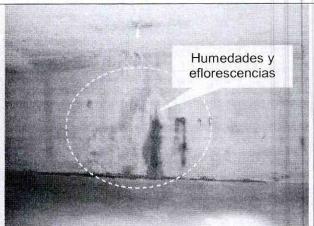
Vista de la cara inferior de la placa aérea de la estructura de sótano; donde se observa deformación de la placa y presencia de eflorescencias en el concreto.
